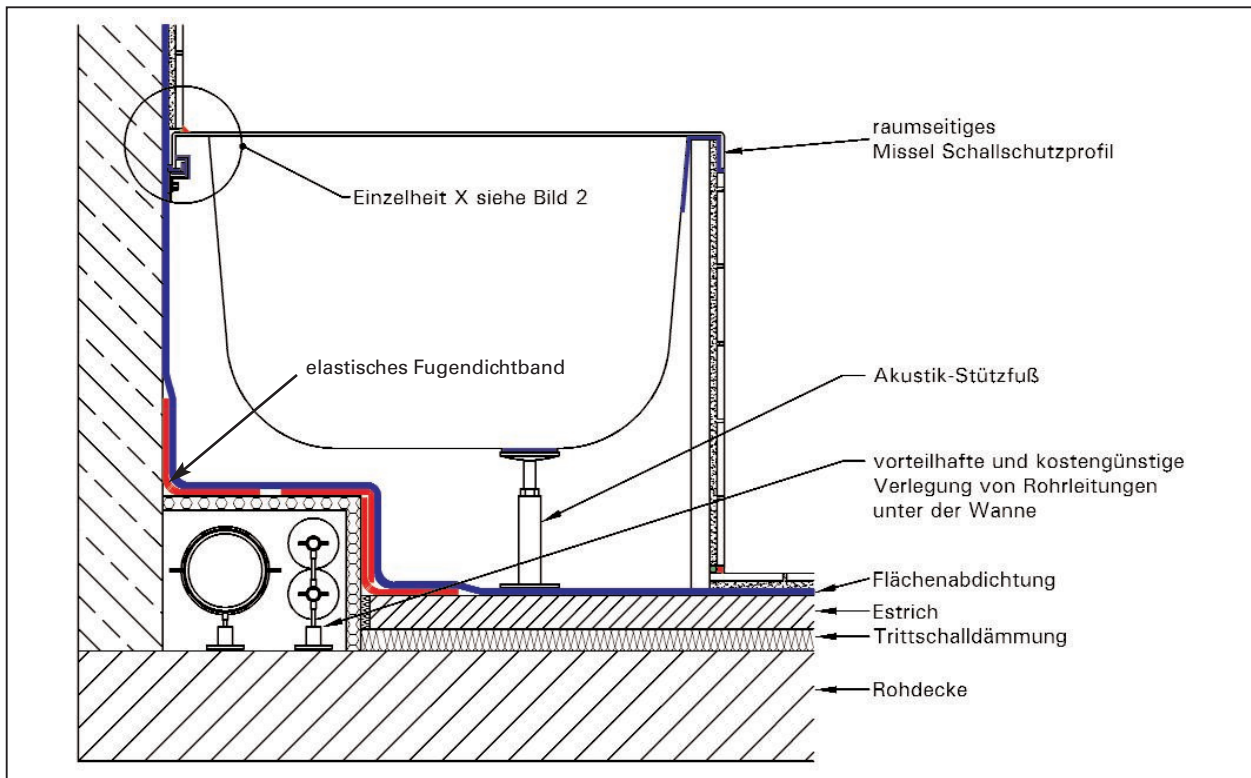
Alternative Boden- und Wandabdichtung unter bzw. im Schwall- und Spritzwasserbereich einer Badewanne; akustisch entkoppelte Wannenmontage mit Missel Universal-Trägersystem für Bade-, Dusch-, Whirlwannen MSB, MSD – Rohrleitungsverlegung vor Flächenabdichtung
